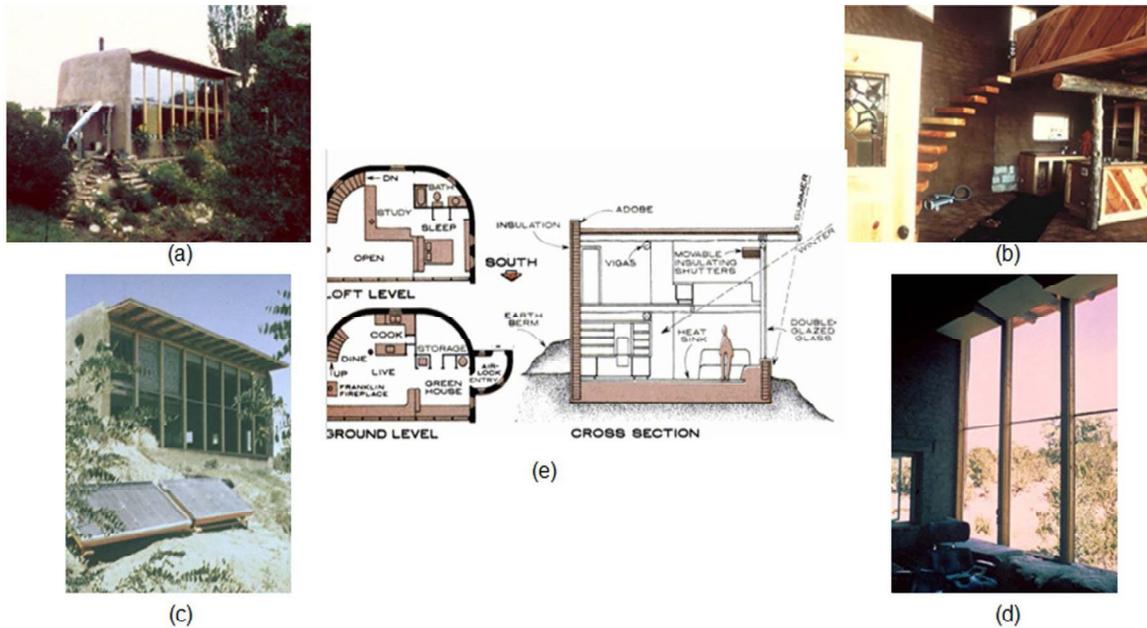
David Wright, Sunscope, Santa Fe, Nuevo México, E.U.A, (1975): (a), (c) Vistas exteriores, (b), (d) Detalle interior, (e) Plantas arquitectónicas y Sección transversal.
